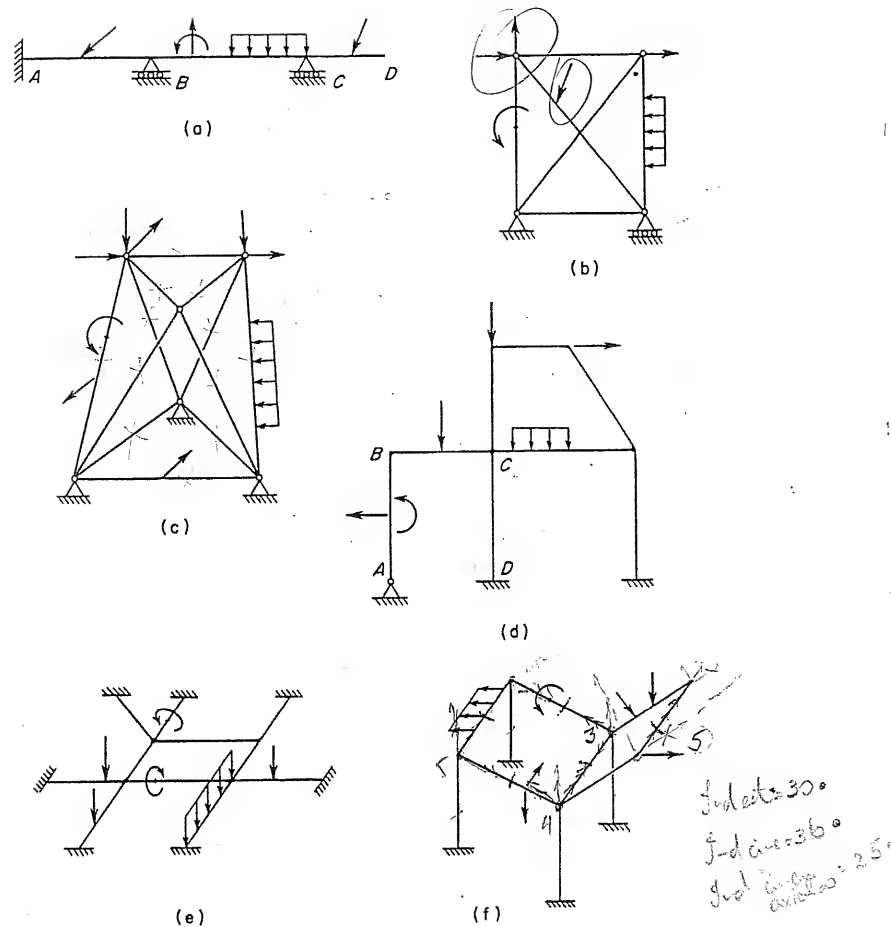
Tipos de estructuras reticulares: (a) viga, (b) armadura plana, (c) armadura en el espacio, (d) marco plano, (e) parrilla y (f) marco en el espacio
